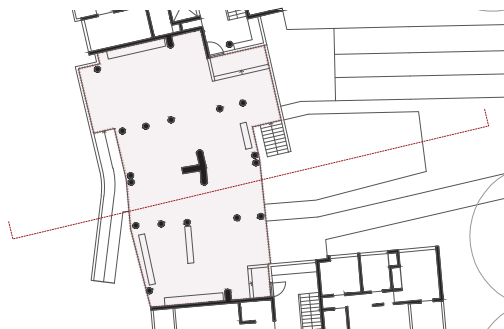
Átrio de entrada, Hansaviertel. Planta Escala 1:500.
